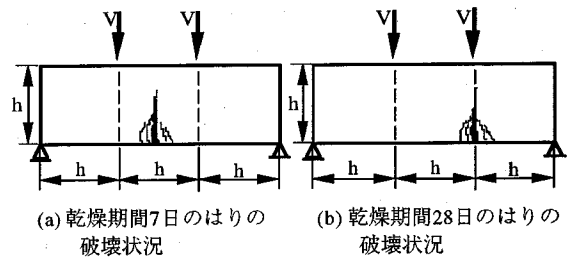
高さ50cmのはりの破壊時のひび割れ状況
